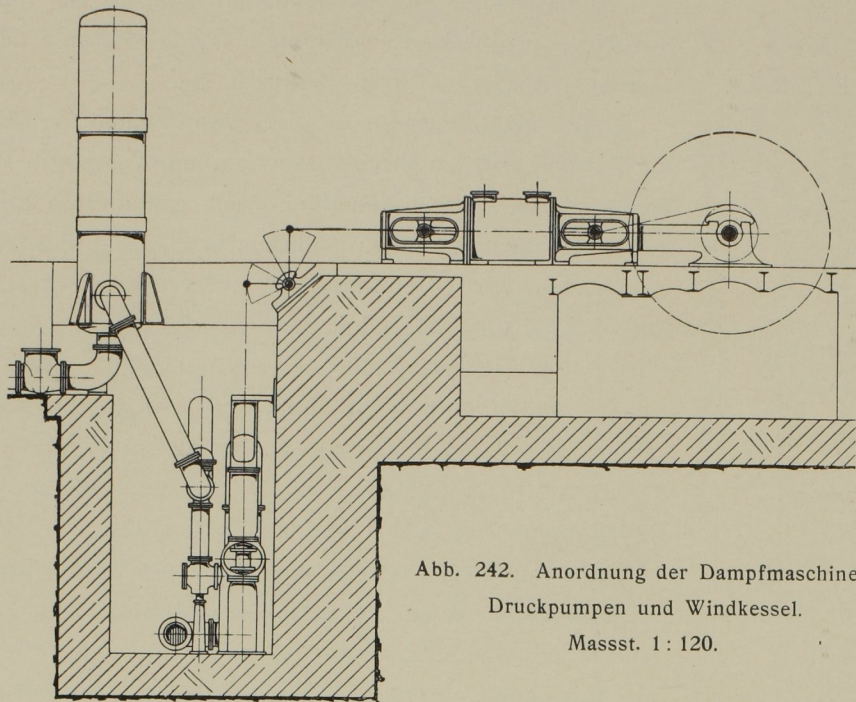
Anordnung der Dampfmaschinen, Druckpumpen und Windkessel.
